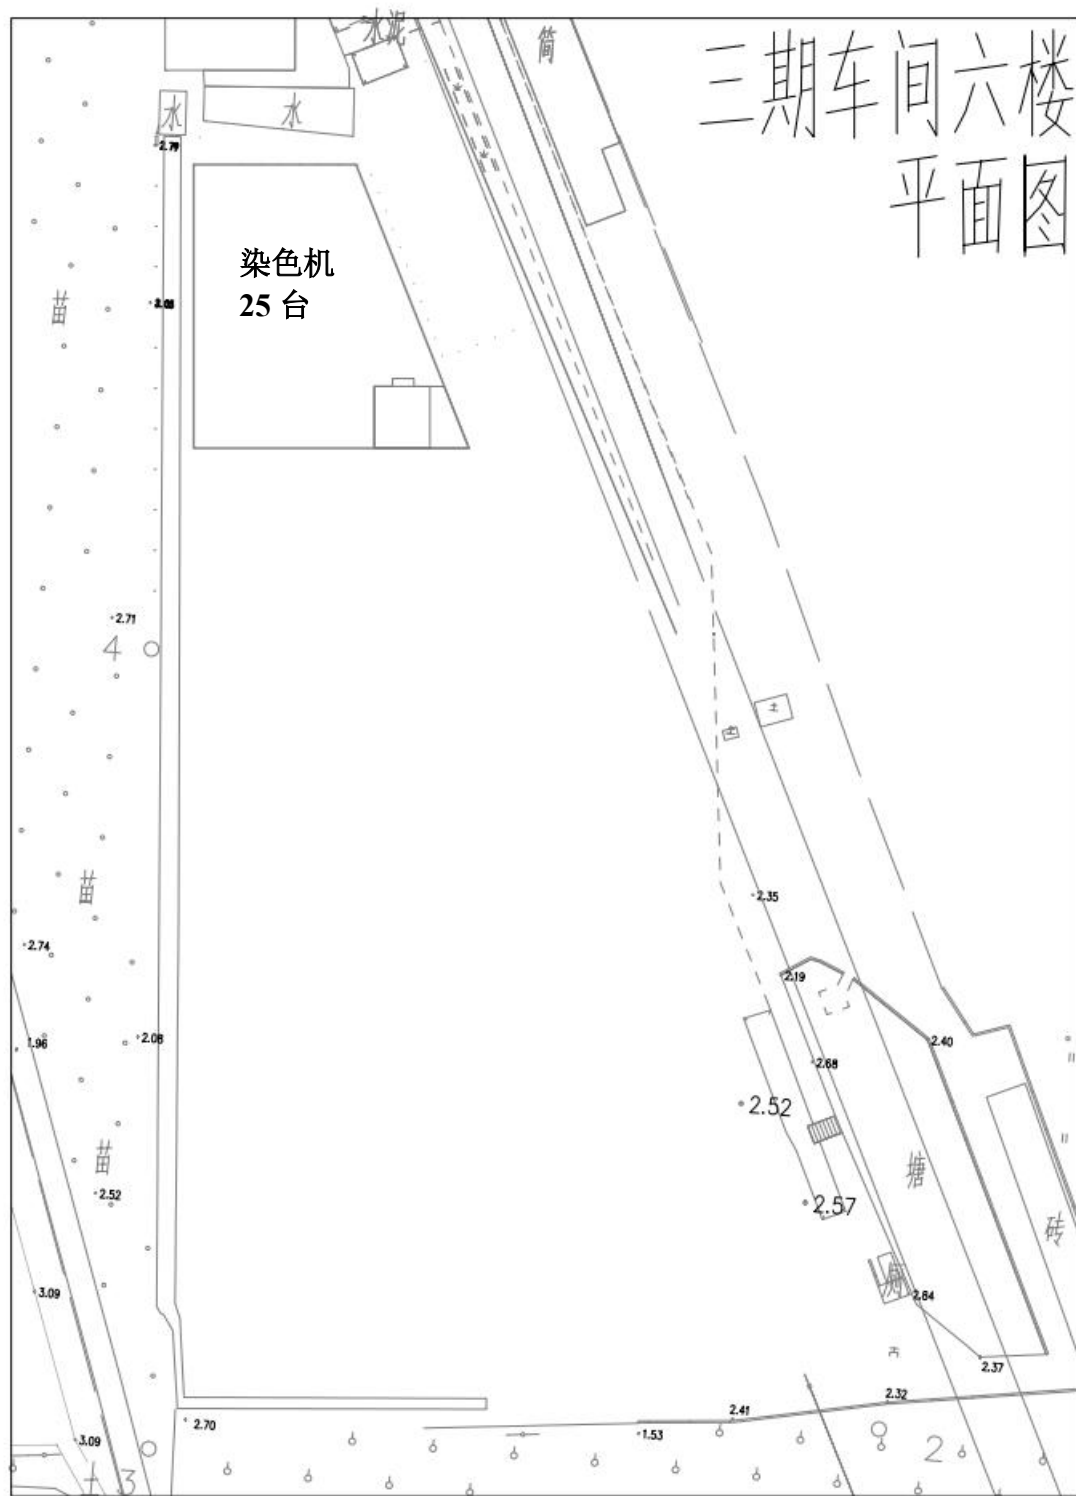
项目六层平面布置图（比例尺 1: 600）
